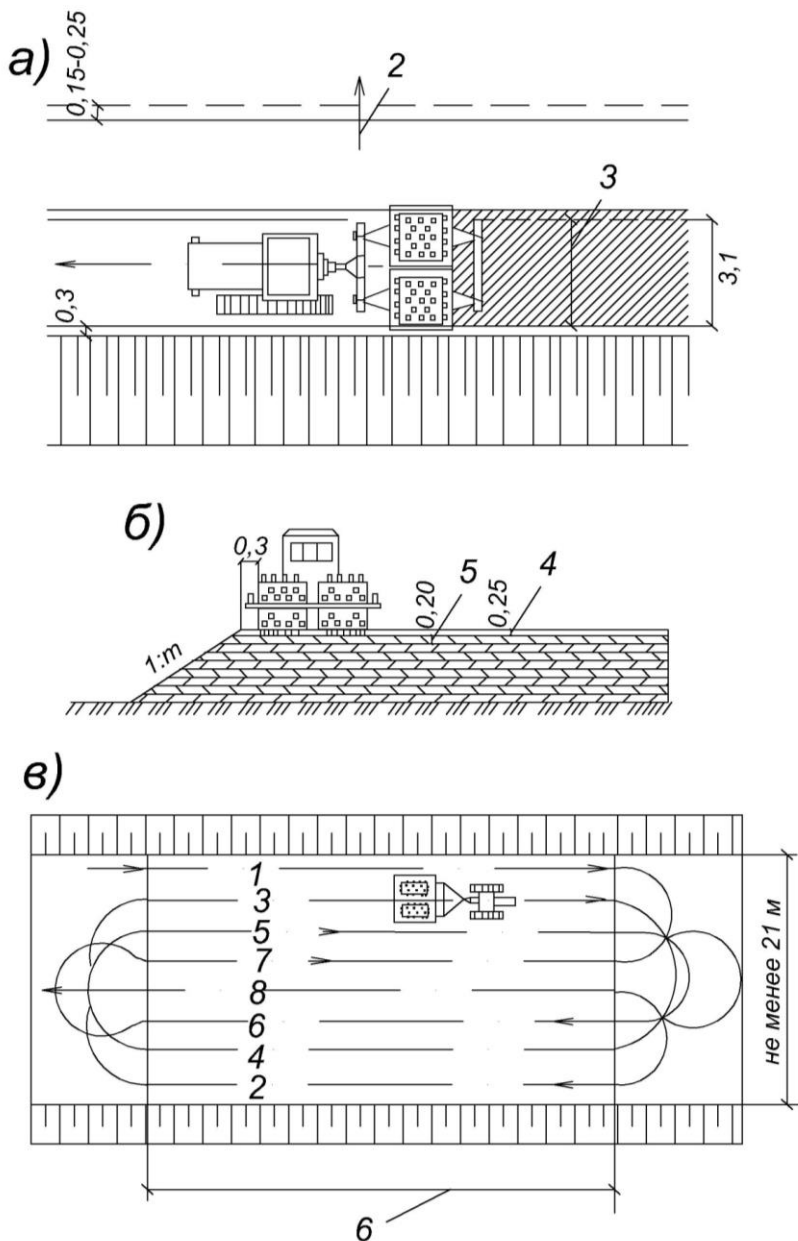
Схема уплотнения насыпи катками: а - план; б - разрез; в - схема движения машины; 1 - перекрытие полос укатки; 2 - направление укатки от краев насыпи к ее середине; 3 -
